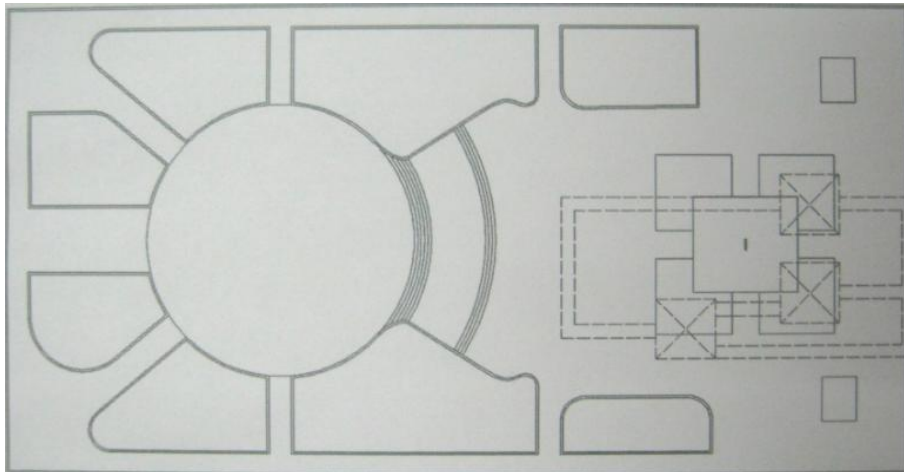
Planta baixa da proposta de reconfiguração da Praça do Carmo. Fonte: FUMBEL, 1996.
